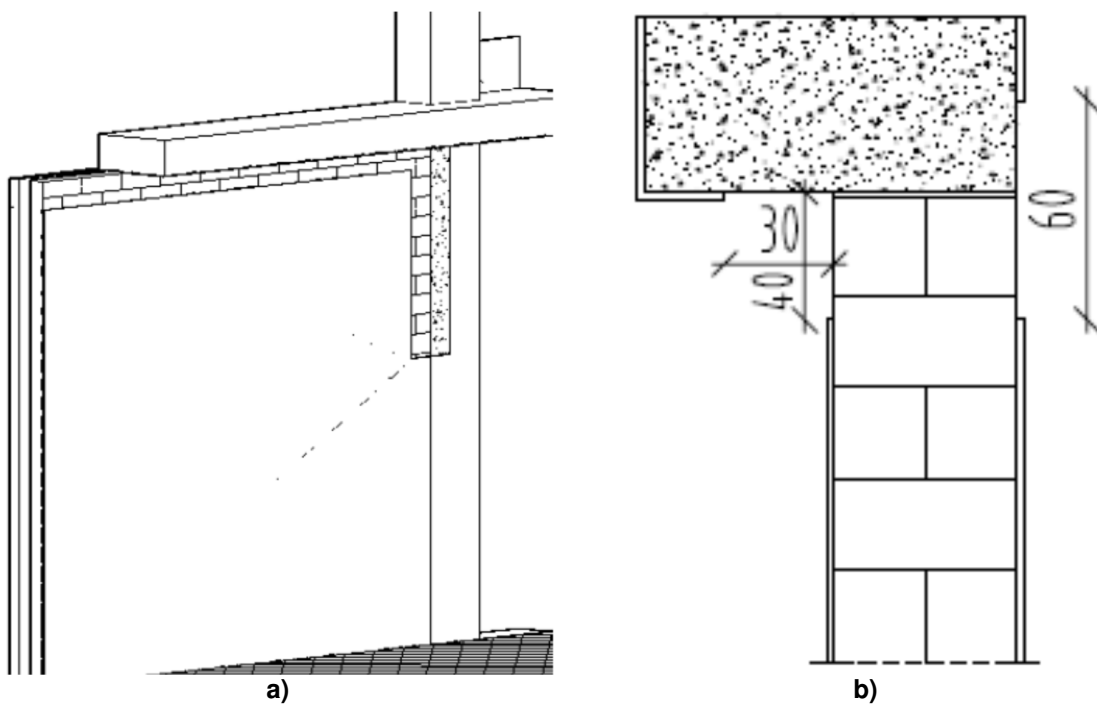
Conexión perimetral a placas y columnas: Paso 1. a) Vista tridimensional; b) Sección transversal.
